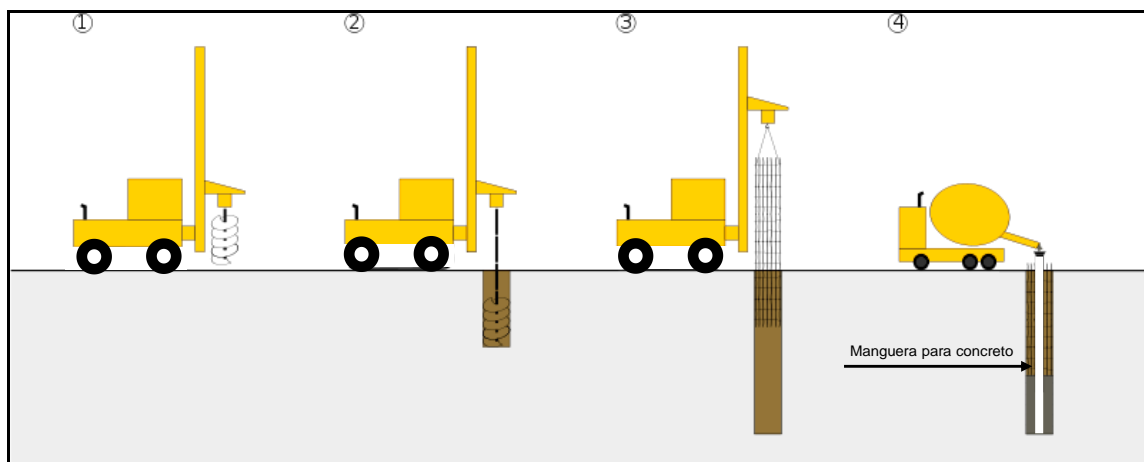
Procedimiento constructivo para el PILOTE PRE EXCAVADO A MÁQUINA con taladro helicoidal Auger. (Excavación con taladro Auger, colocación del refuerzo de acero, vaciado de concreto). La manguera para transporte del concreto, deberá bajar hasta el fondo de la perforación por el interior de la canasta de acero.
